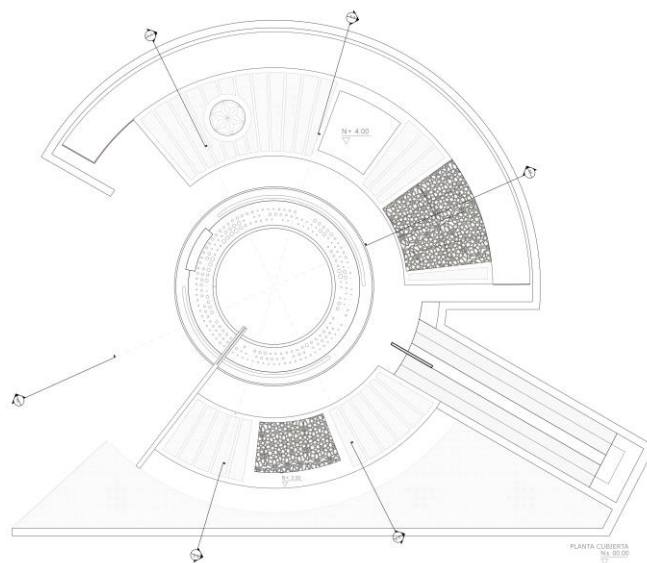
Planta General Cubierta. Esquema realizado por la autora
